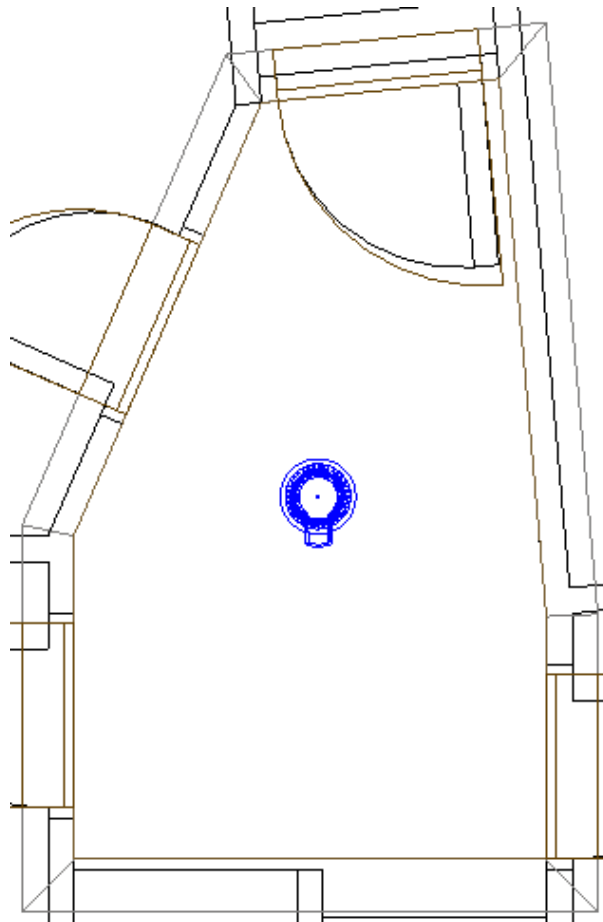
Plano del área de circulación de la segunda planta de la vivienda unifamiliar.
